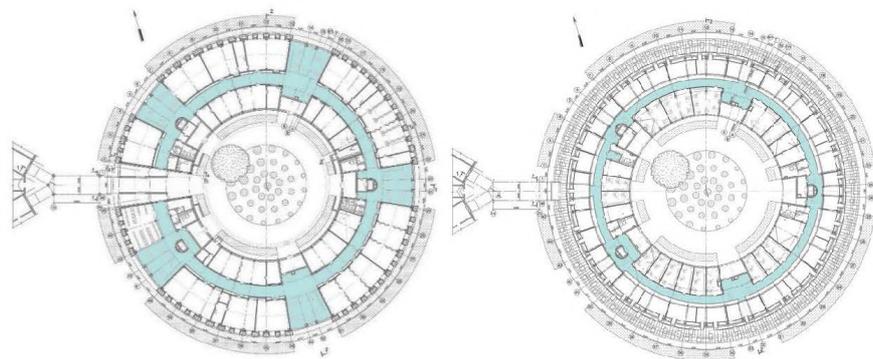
План 1 этажа и план 2 этажа павильона «Школа»
